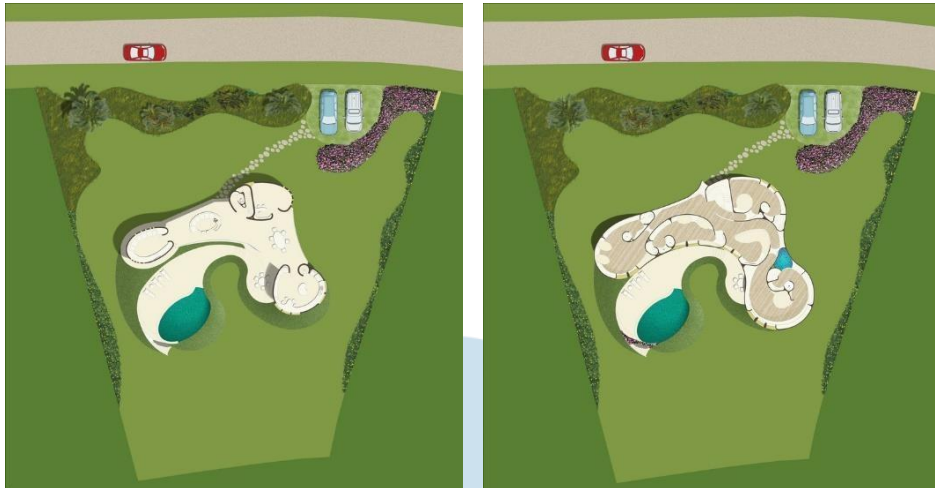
Gambar Interior Bangunan Kiri Lantai 1 Dan Kanan Lantai 2
